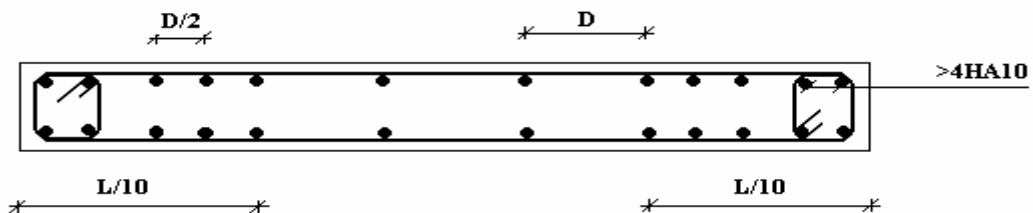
Disposition des armatures verticales dans les voiles.
